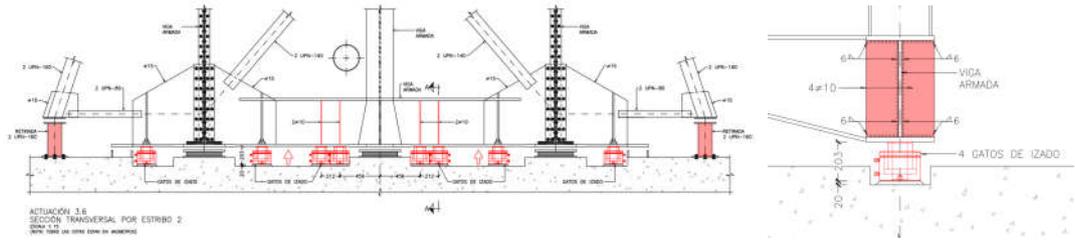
Colocación de rigidizadores en arriostramiento transversal inferior
